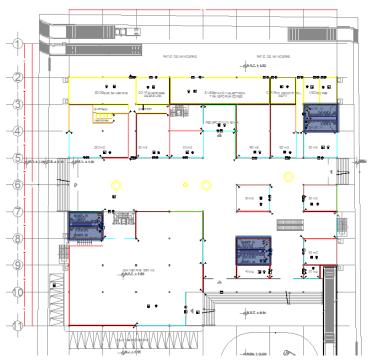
Ubicación en el plano de zonas de servicios generales públicos. Fuente: Elaboración propia.
